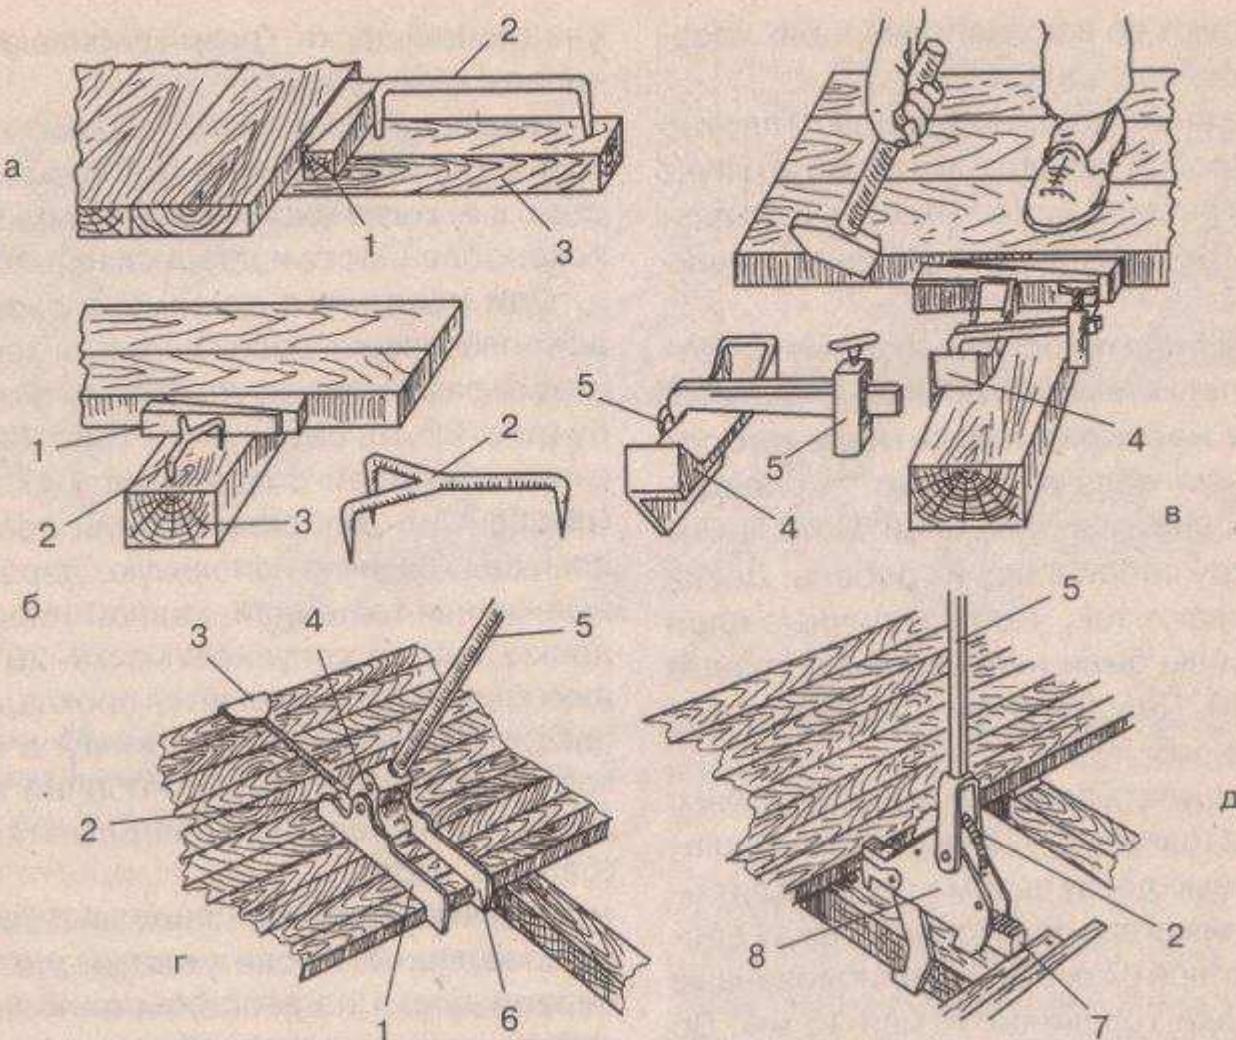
Сжимы для сплачивания досок пола: а — строительная скоба; б — сжим скоба; в — сжим клиновой с подвижной скобой; 1 — клин, 2 — скоба, 3 — лага, 4 — клиновой сжим, 5 — шпора, 6 — подвижный упор; г — рычажно-зубчатый сжим; д — рычажно-зубчатый сжим с храповым колесом и зубчатой рейкой; 1 — станина, 2 — храповое колесо, 3 — зажимная скоба с канатом, 4 — барабан, 5 — трубчатый рычаг, 6 — упор станины, 7 — зубчатая рейка, 8 — корпус
